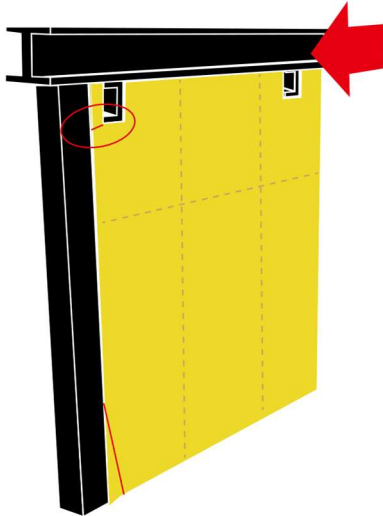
上張りボード上角部に生じるひび割れ、下角部に生じるしわ・折れのイメージ図
